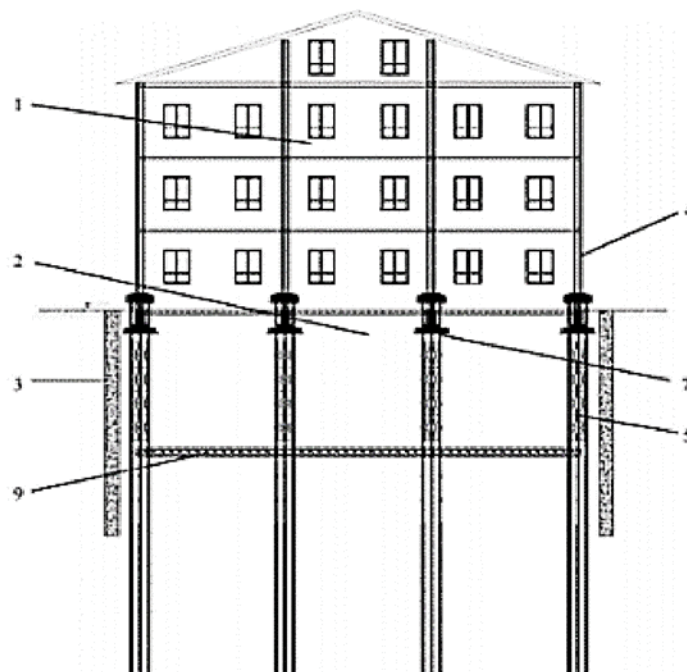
Схема влаштування підземного поверху: 1 - будівля; 2 - підземна споруда; 3 - контур огорожі підземної частини; 4 - існуючі стіни та/або колони будівельних конструкцій; 5 - в'язі по палях; 7 - оригінальний фундамент; 9 - нижня плита підземної споруди
